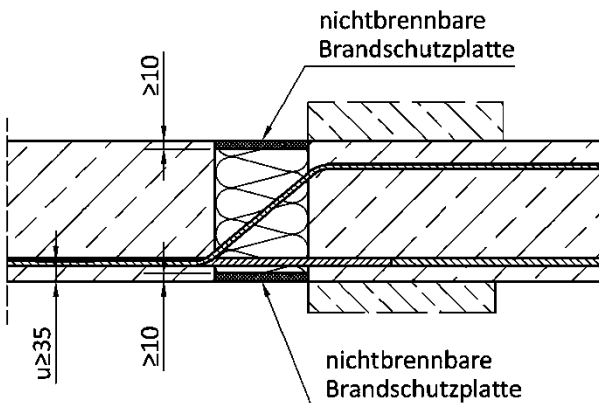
Ausführung ISOPRO Typ Q mit integrierte in Bauteilebene durchgehende nicht brennbare Schicht nach Abschnitt 2.1.3 (exemplarisch links: mit SCB; rechts: mit HPCB)
